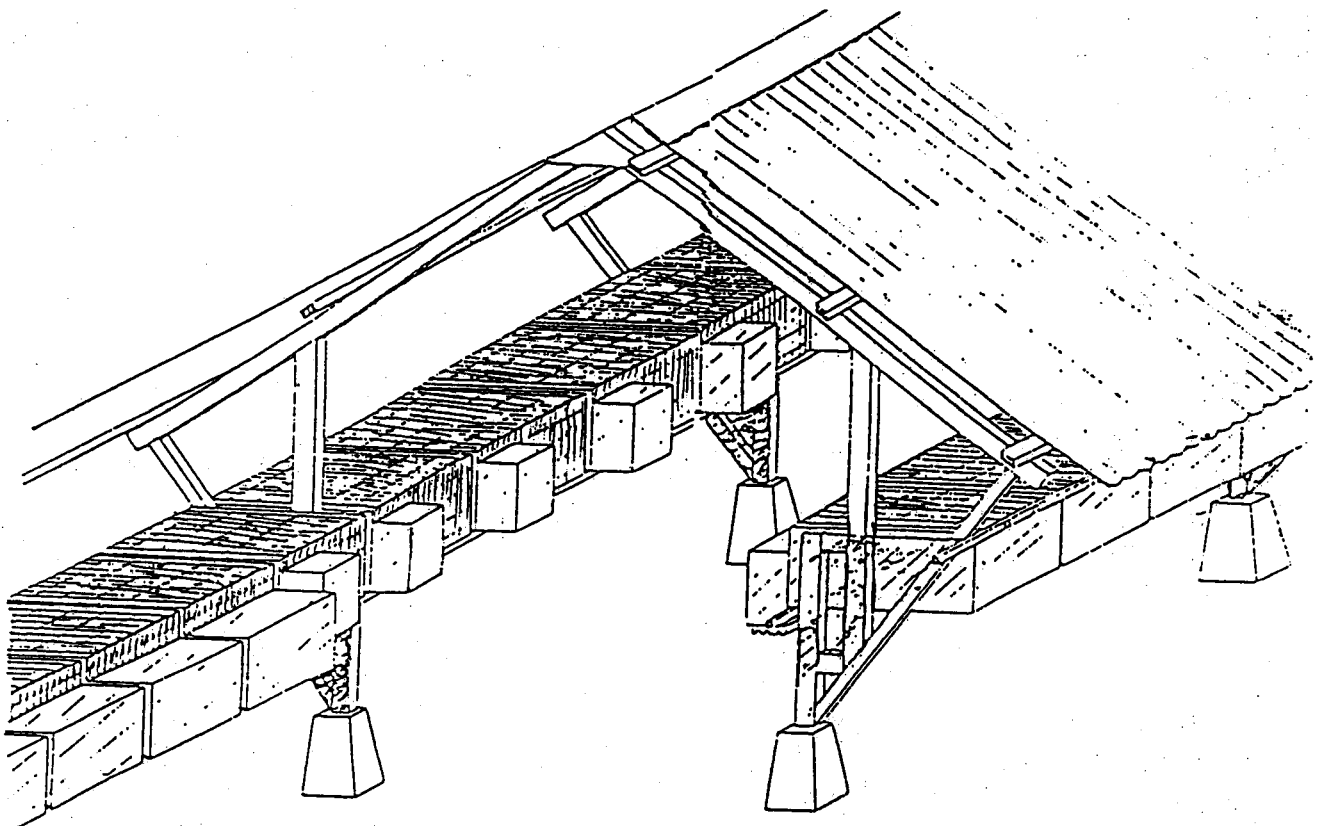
Modelo de estructura al aire libre moderna con techo de doble vertiente y pasillo central, con soportes y armazón de madera.
